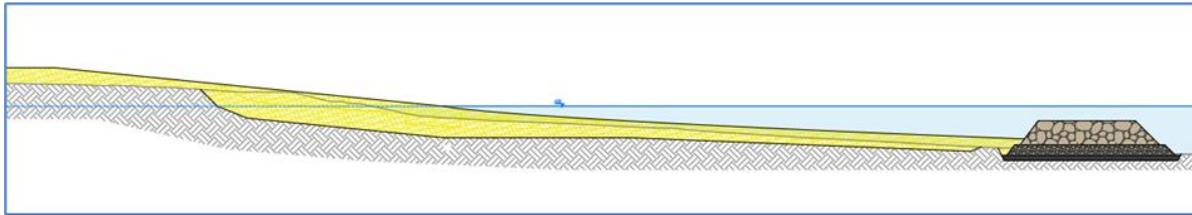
Realizzazione del ripascimento: sezione trasversale tipologica di progetto
